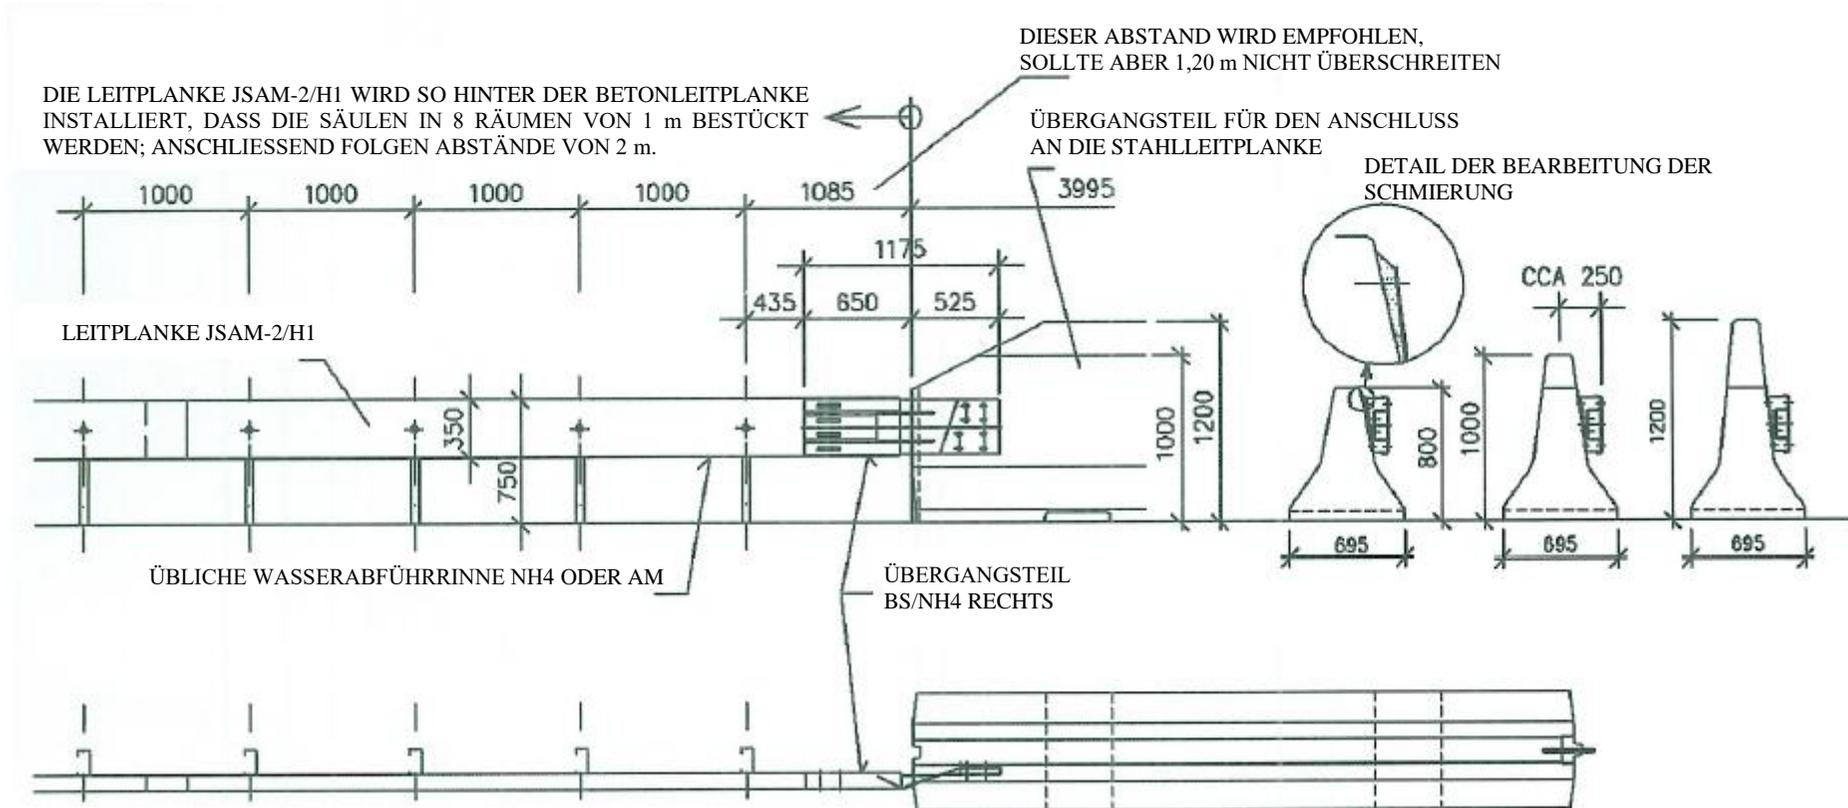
Beispiel für den Anschluss der Stahlleitplanke JSAM-2/H1
